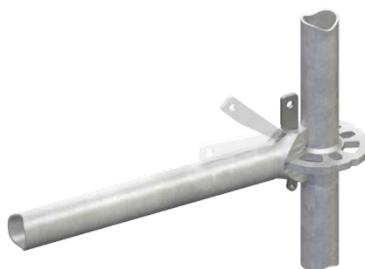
Vista en planta de un nudo DokaScaff
